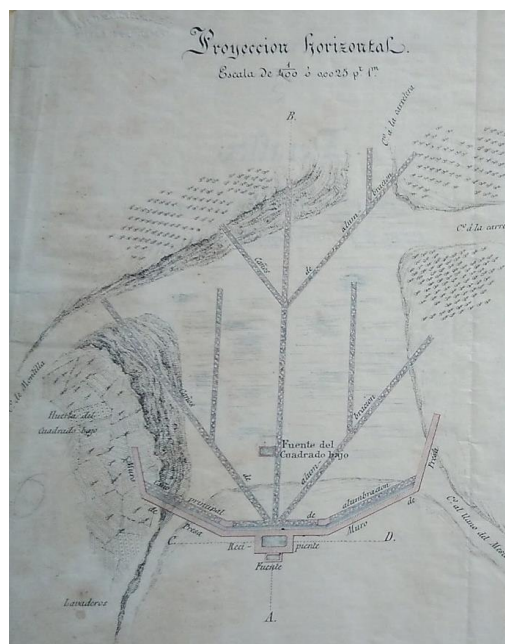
Detalle de la proyección horizontal del sistema de captación.
